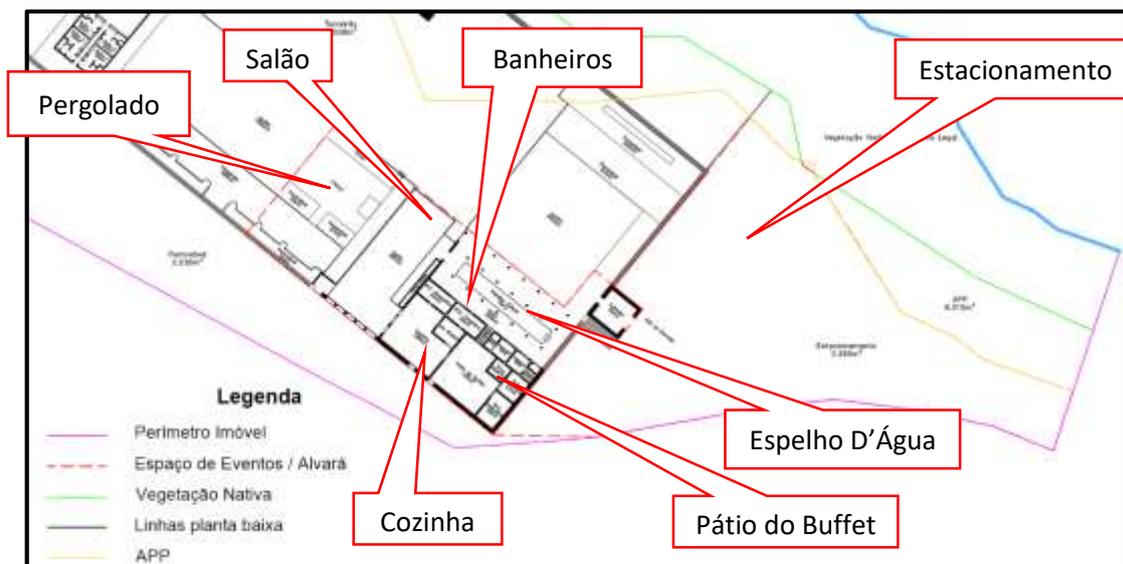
Detalhe da Planta Baixa – Área da Atividade.
